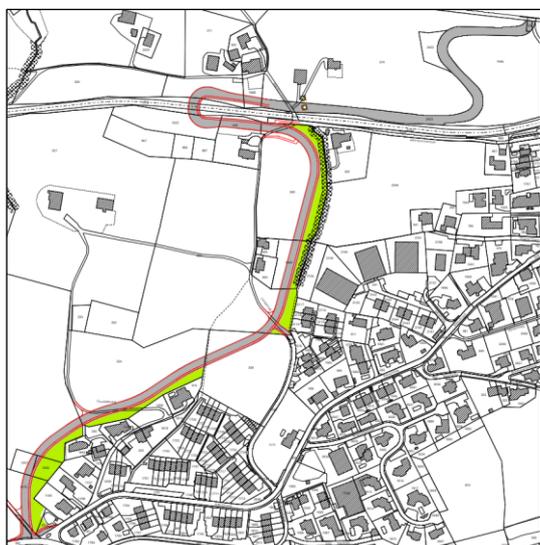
Ausschnitt Änderungsplan, Quelle: r+k
